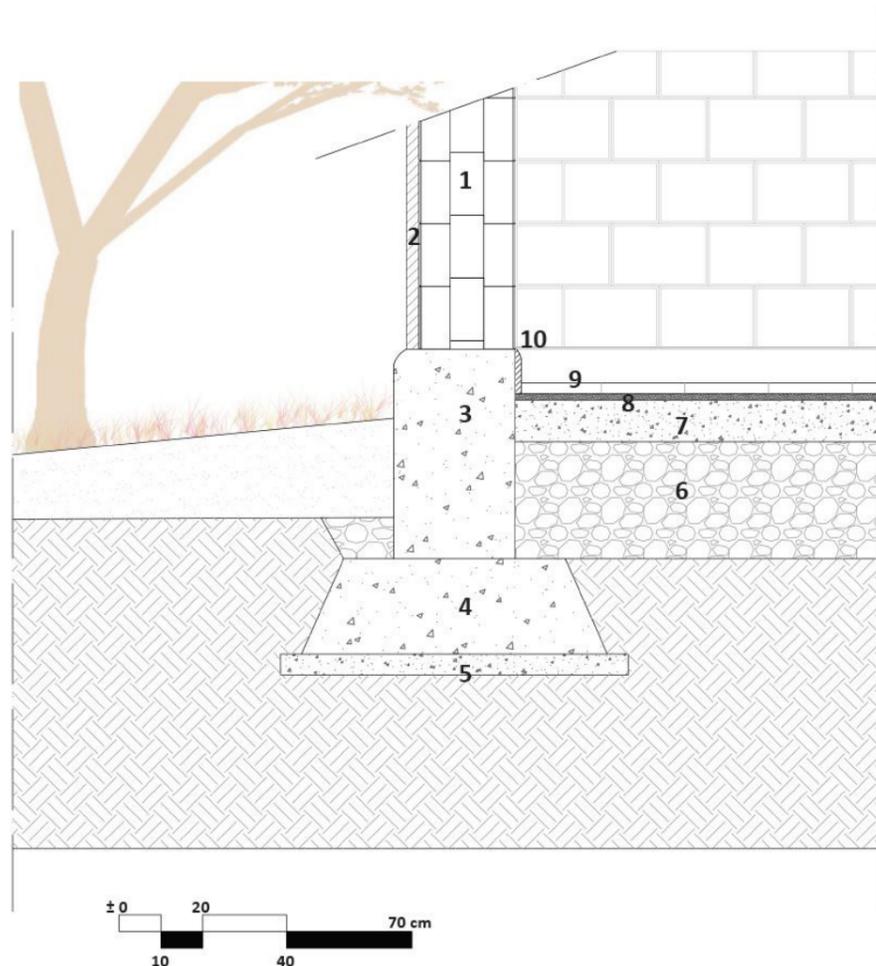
Sezione della fondazione con basamento e pavimento in terra stabilizzata. (Elaborazione propria).
